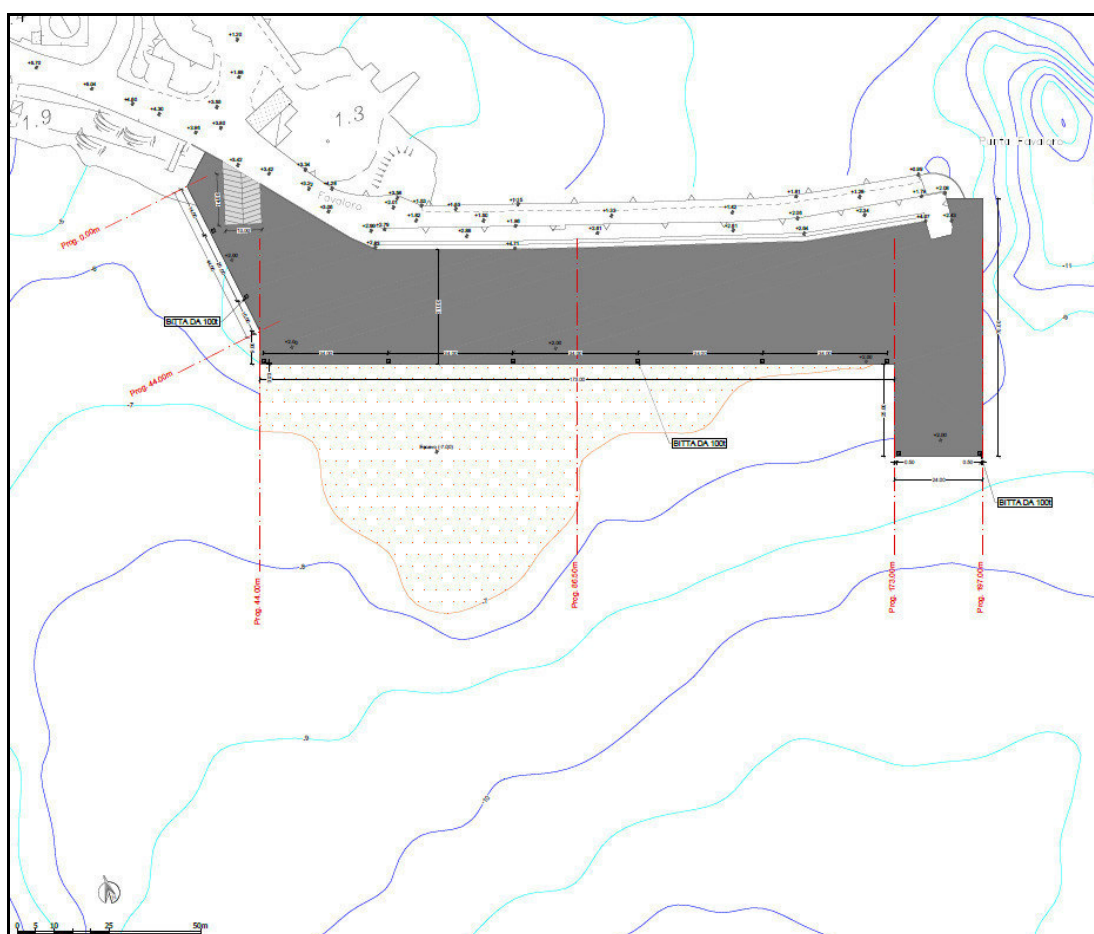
planimetria di progetto della banchina del molo Favaloro (fuori scala)
